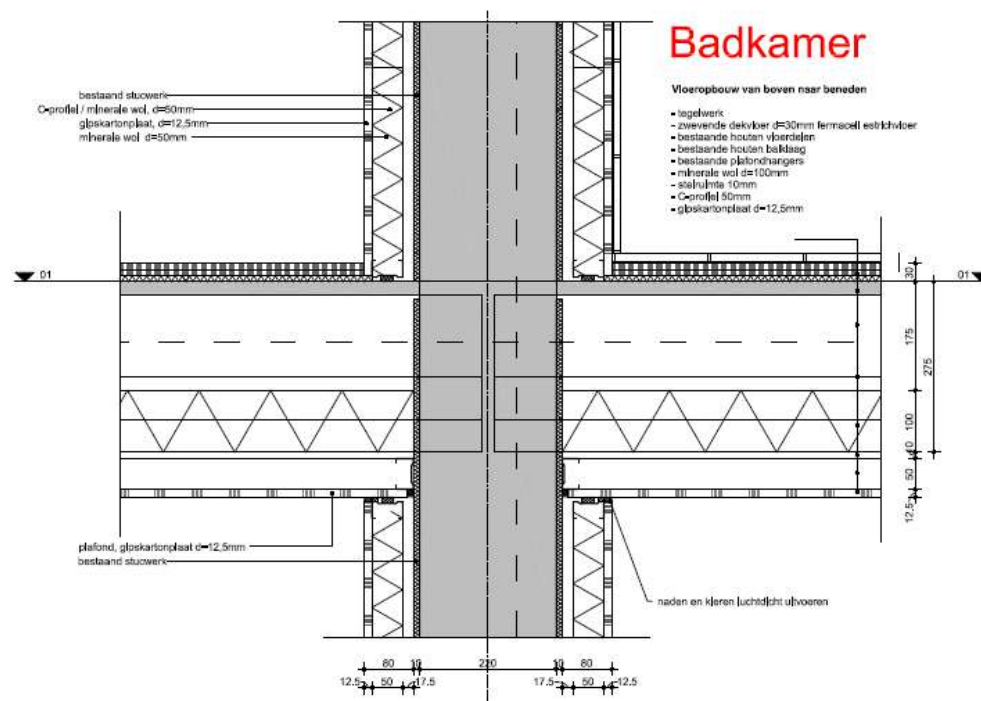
## DETAILLERING BADKAMERVLOER / WAND (VOORBEELD)
